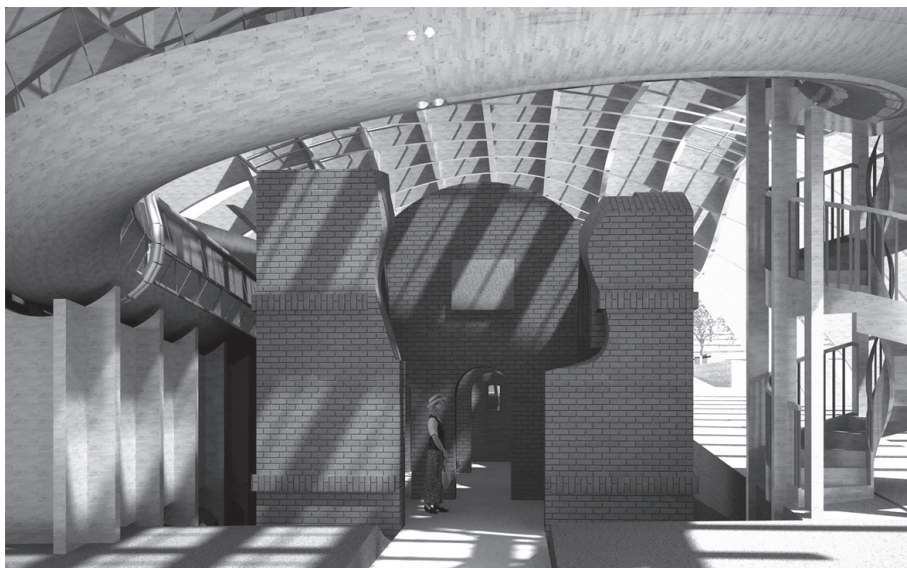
Randări (ansamblu și detaliu alcătuire) / Renders (general and construction detail)
